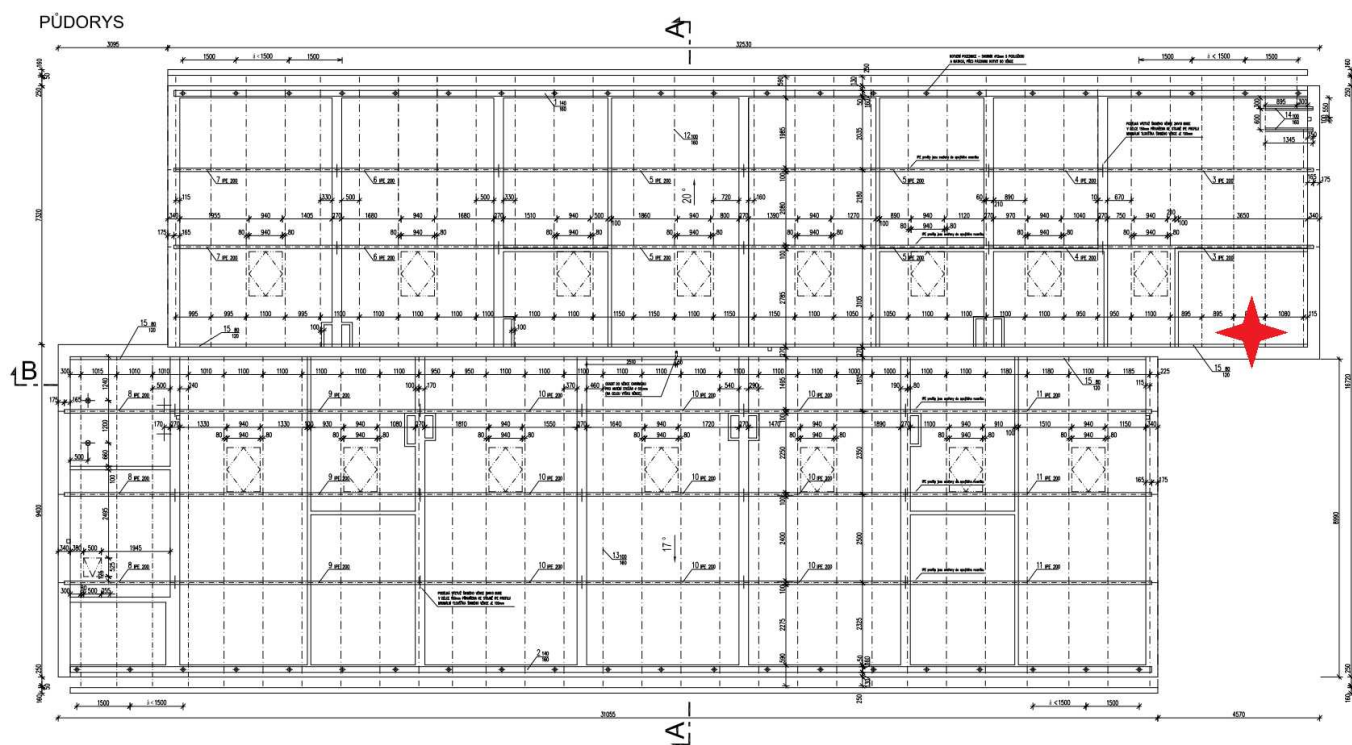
/ Poloha provedené sondy v půdorysu krovu střechy dle [9] (červeně, severní strana je napravo)
